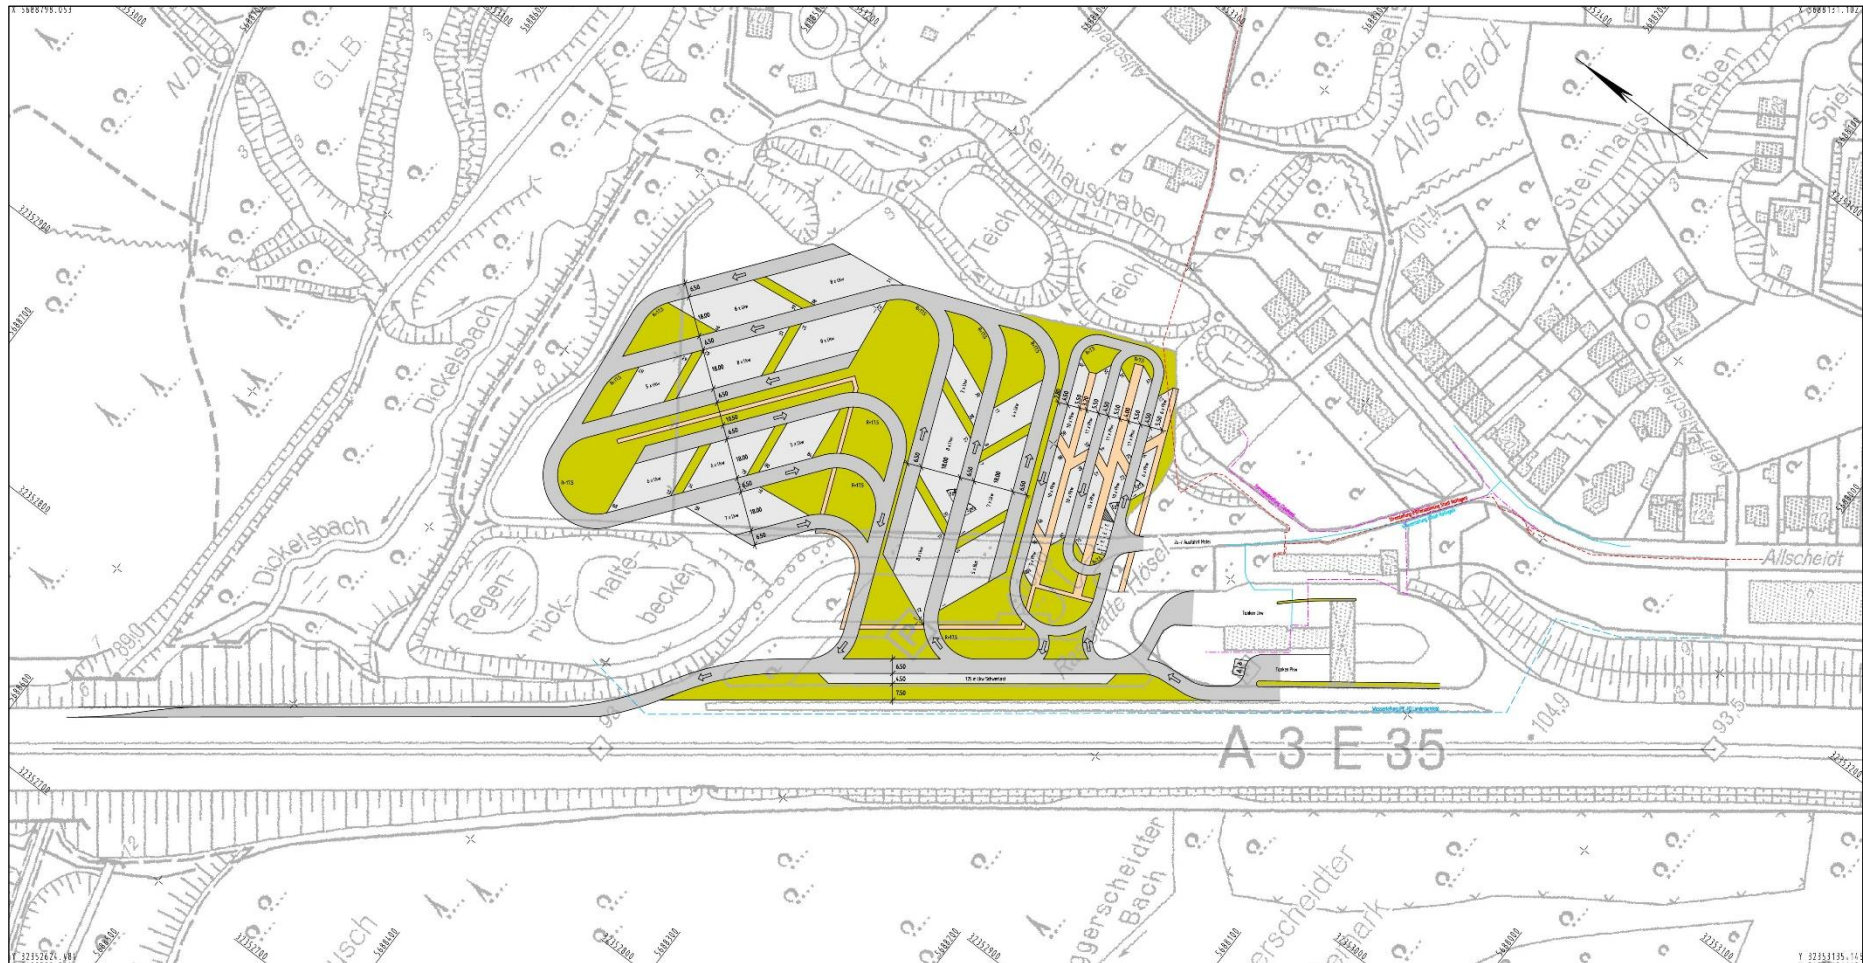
Lageplan der Variante 3 (Quelle: INGENAix GMBH 2018)
